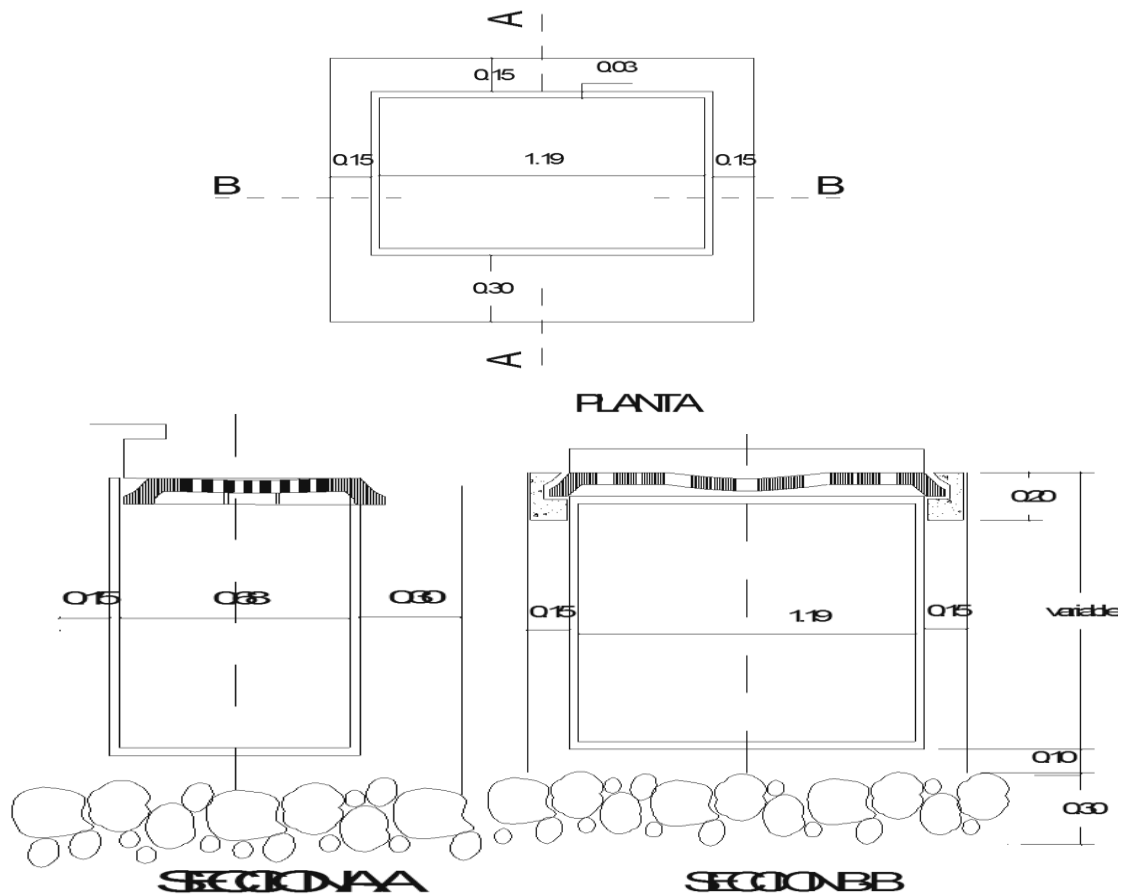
Detalle de caja tragante con parrilla de hierro fundido.
